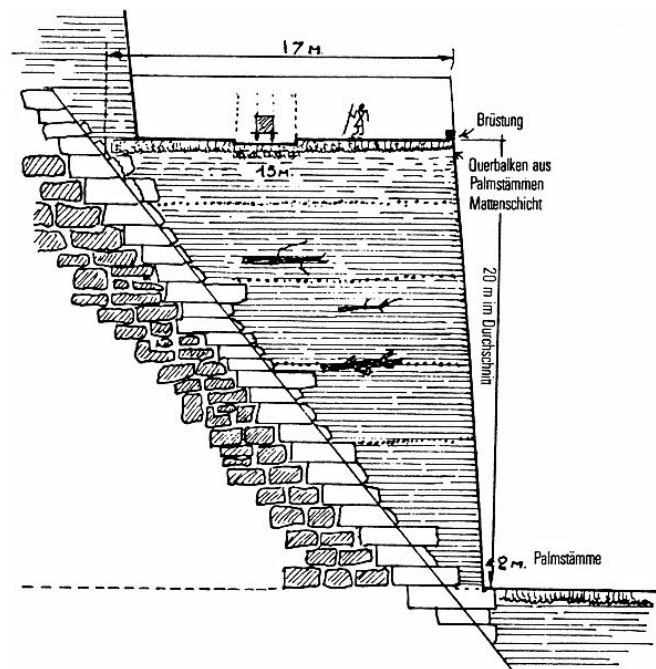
Prinzip einer umlaufenden Rampe nach Goyon (Schnitt)
